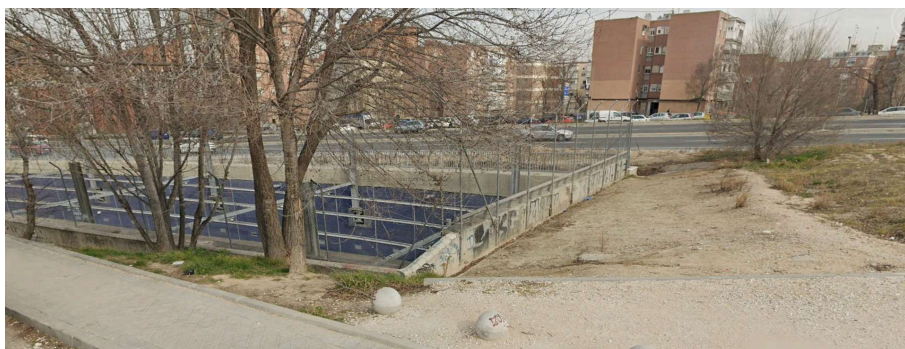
Soterramiento de la Línea ML3 de Metro Ligero.
